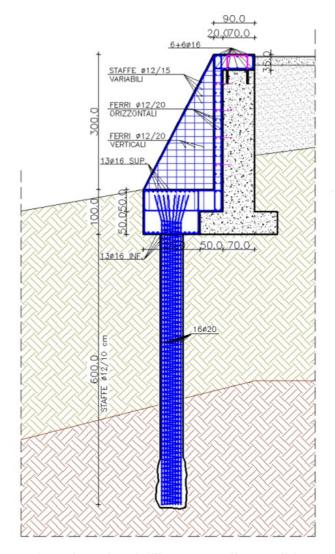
Estratto dell'elaborato 8, sezione tipo dell'intervento di consolidamento
